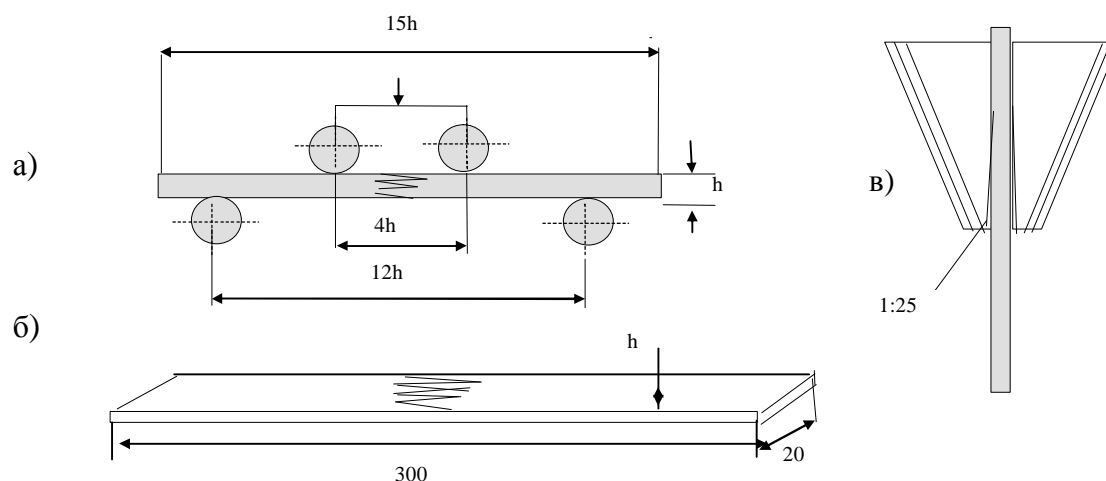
Схемы испытания образцов с зубчатыми соединениями: а - на статический изгиб, б - образец для испытания на растяжение вдоль волокон, в - зажим для испытаний на растяжение
